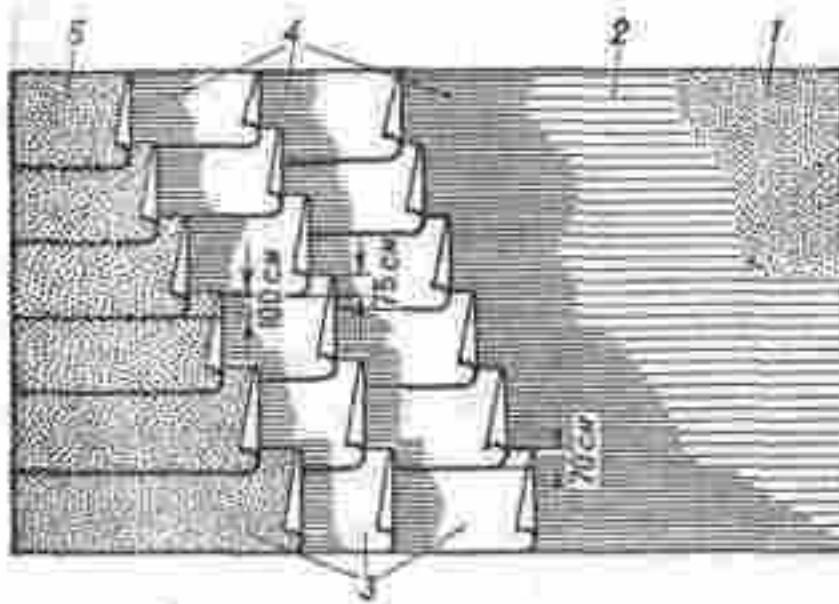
Схема расположения полотно кровельного ковра трёхслойной рулонной кровли: 1 — основание; 2 — оштукатурка холодной мастикой; 3 — трёхслойная кровля; 4 — приклеивающая мастика; 5 — защитный слой.
